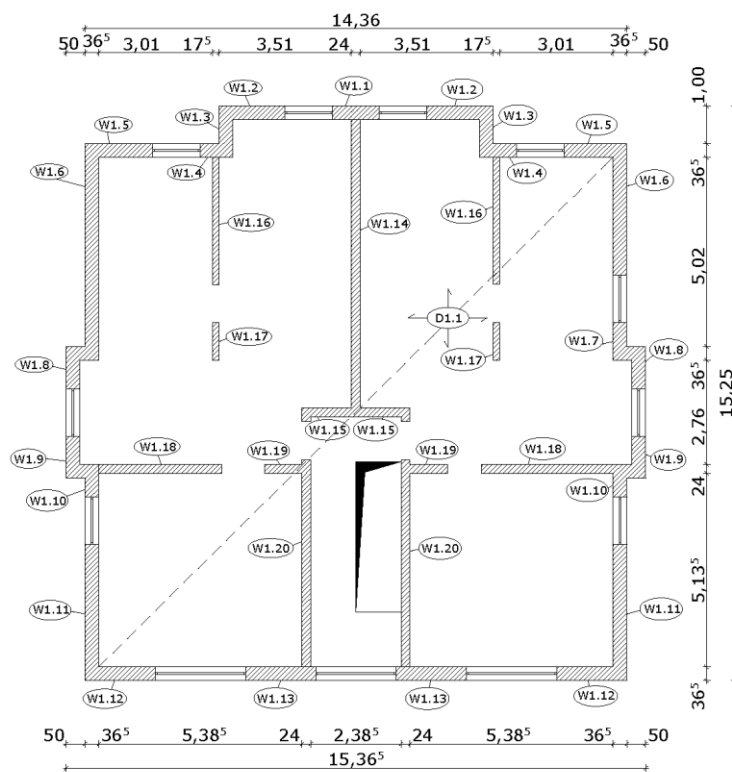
Grundriss des 1. Obergeschosses nach [2]
